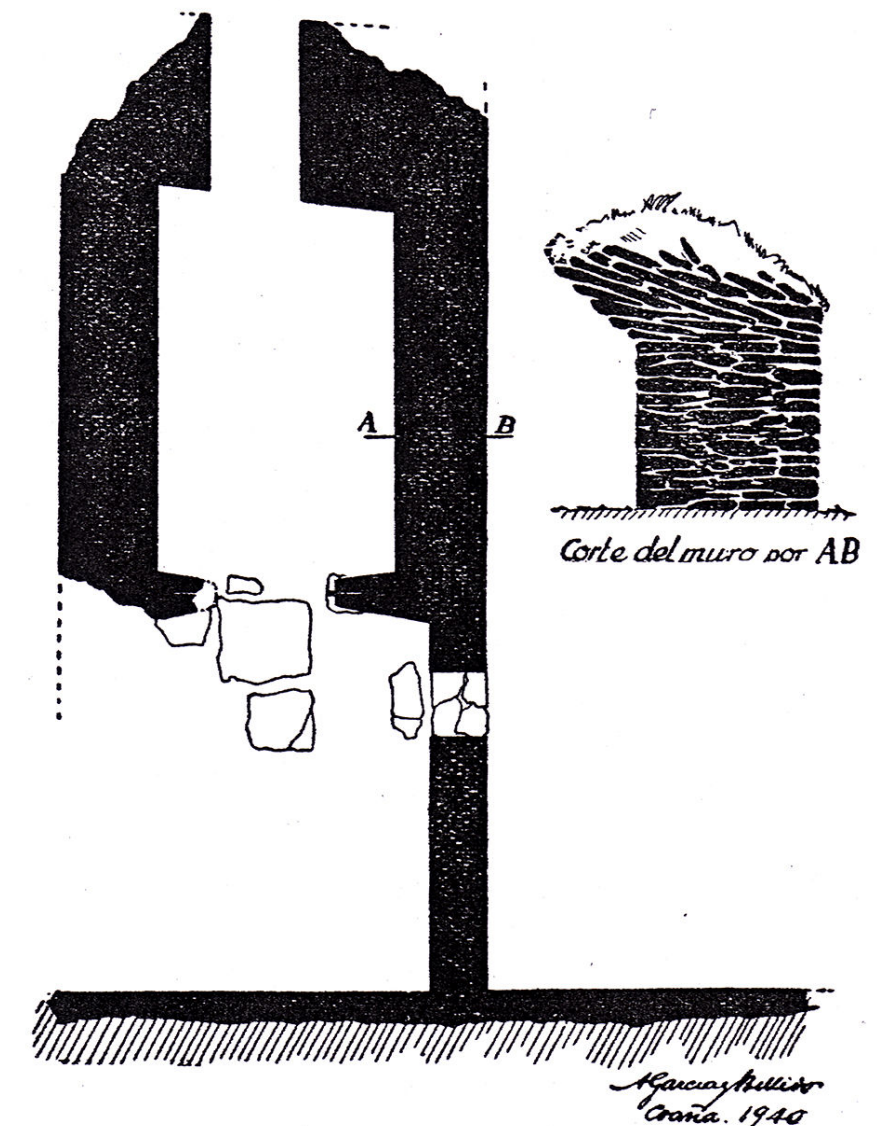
Planta y sección del muro del “Recinto Sacro” del Castro de Coaña. Se aprecia la disposición de las lajas de pizarra en el arranque de la falsa bóveda. Dibujo realizado por Antonio García y Bellido en 1940.
